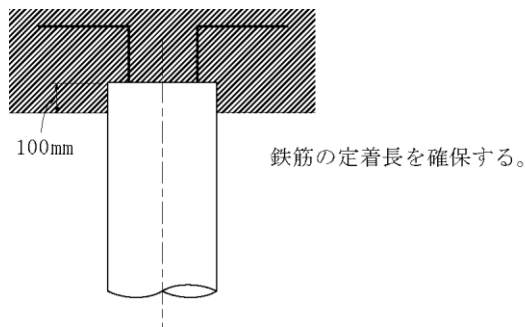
剛結合に準じた標準的な杭頭処理方法
